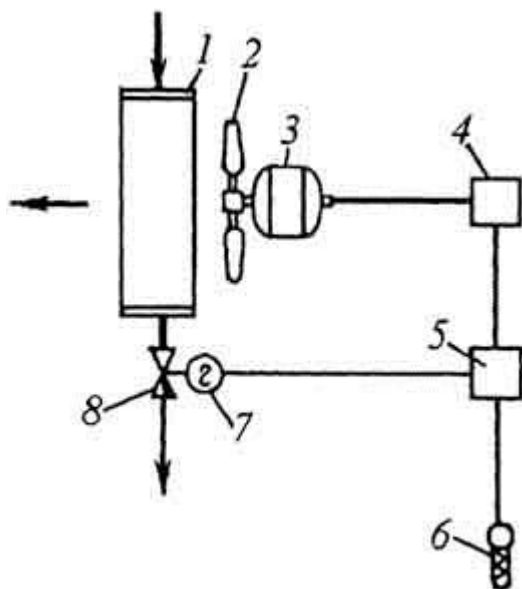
Схема автоматического регулирования работы воздушного отопительного агрегата: 1 - калорифер; 2 - вентилятор; 3 - электродвигатель; 4 - магнитный пускатель; 5 - промежуточное реле; 6 - датчик температуры; 7 - исполнительный механизм; 8 - регулирующий орган
